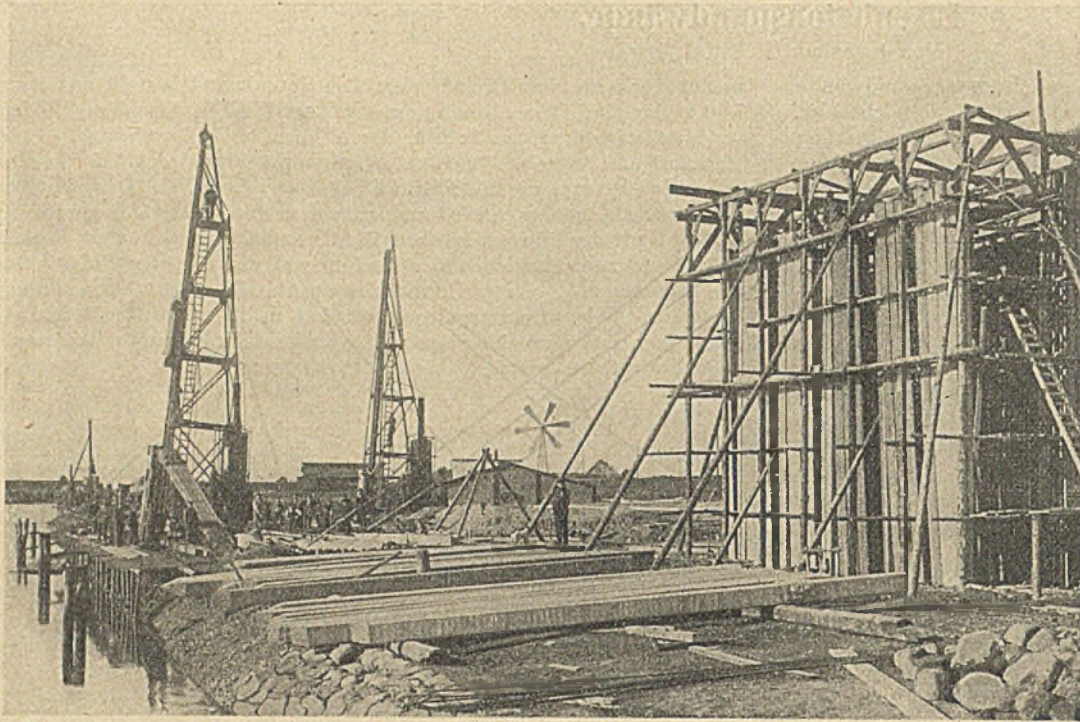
Die Pfähle und Bohlen der Eisenbetonspundwand in Husum werden stehend gestampft.
